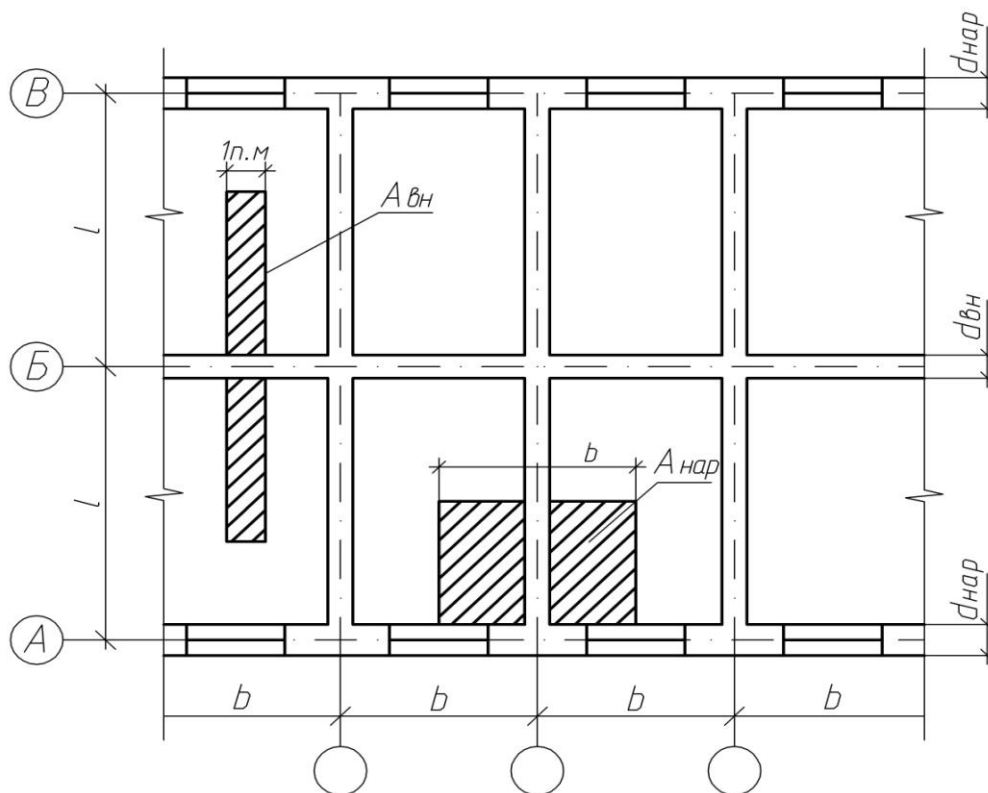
Схематический план здания и определение грузовых площадей
